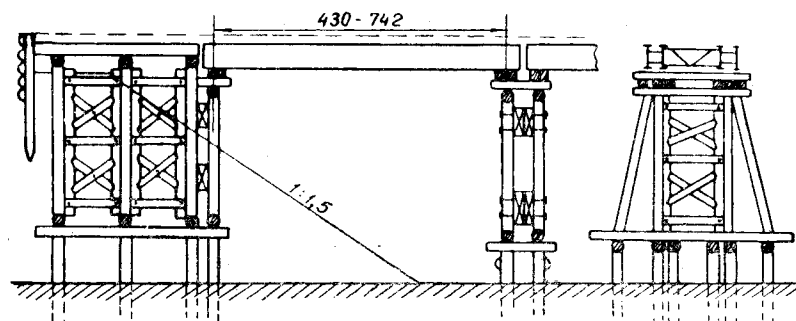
Типовая схема временного деревянного малого моста с «узкими» опорами (при высоте насыпи до 6 м)
